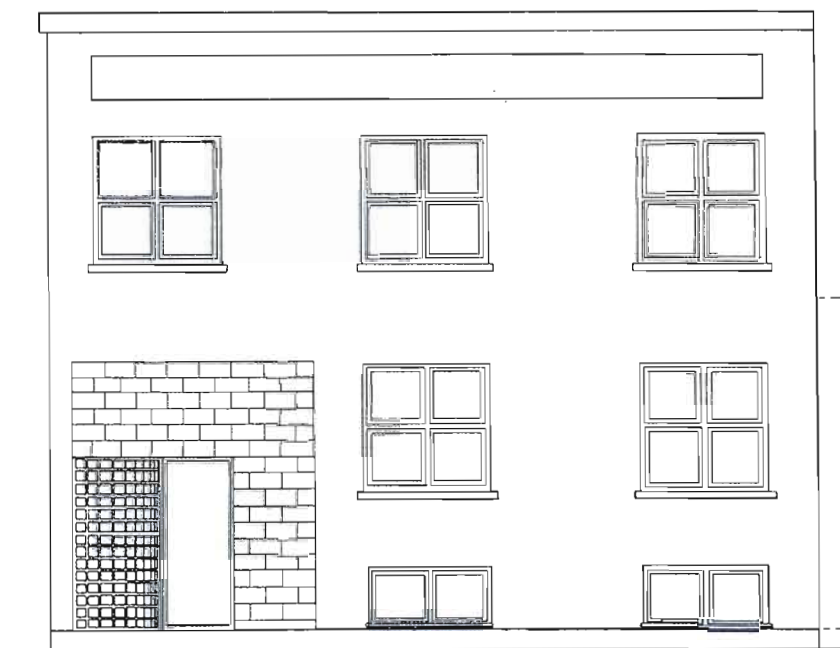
Élévation de la façade principale du 4666, 4668, rue De Bullion. Source : Archives Marc Blouin.
